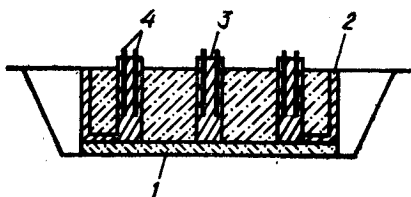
Схема сборно-монолитного фундамента под оборудование:
